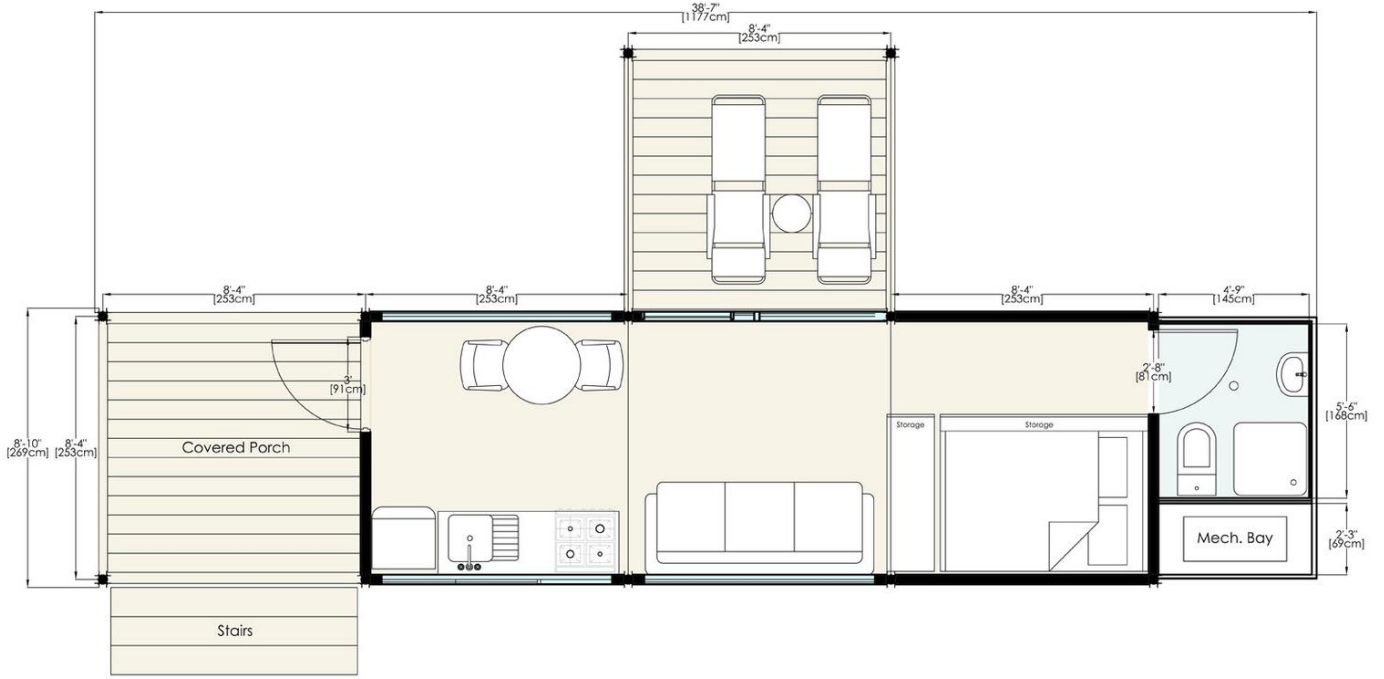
Katrina Cottage ve Plan Şeması (Özge, 2019)
